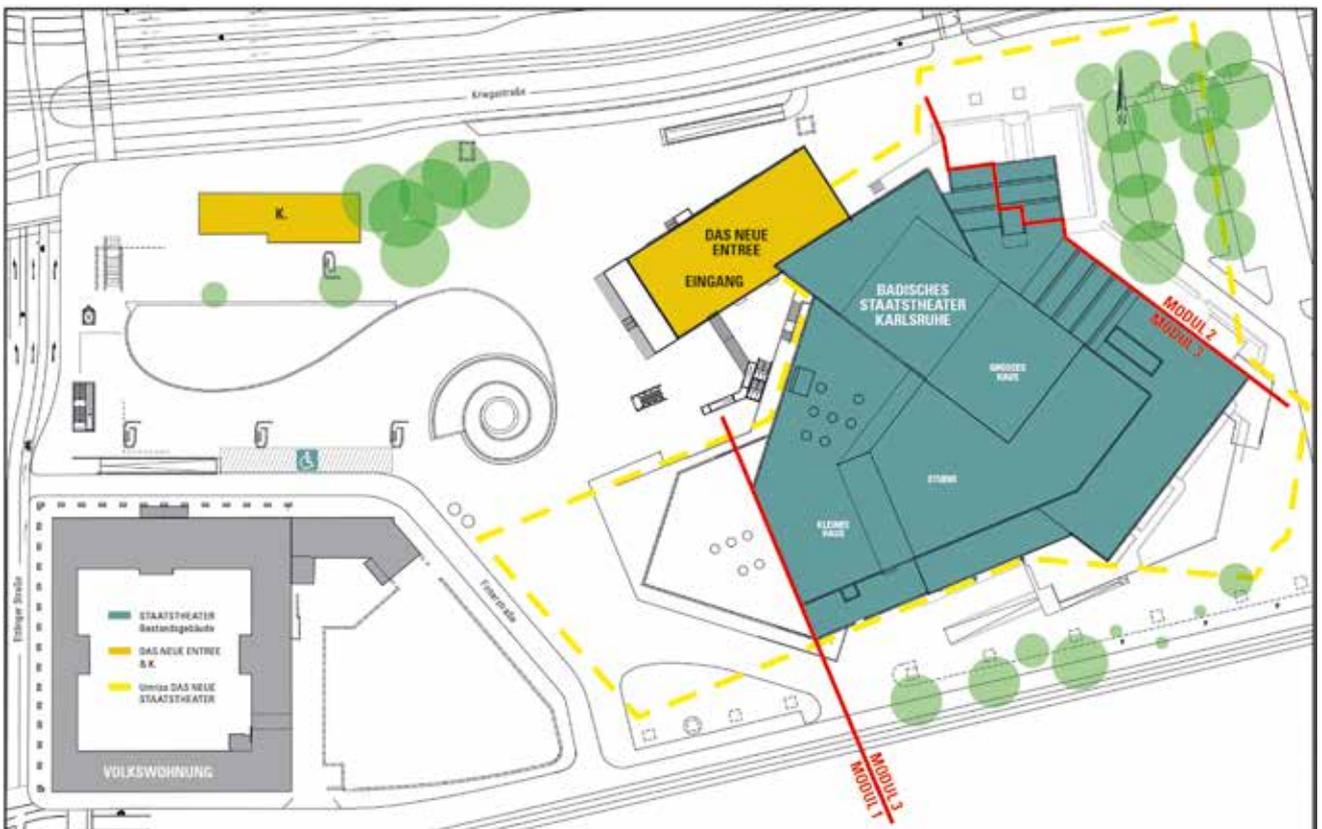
Bestandsgebäude und neuer Grundriss
